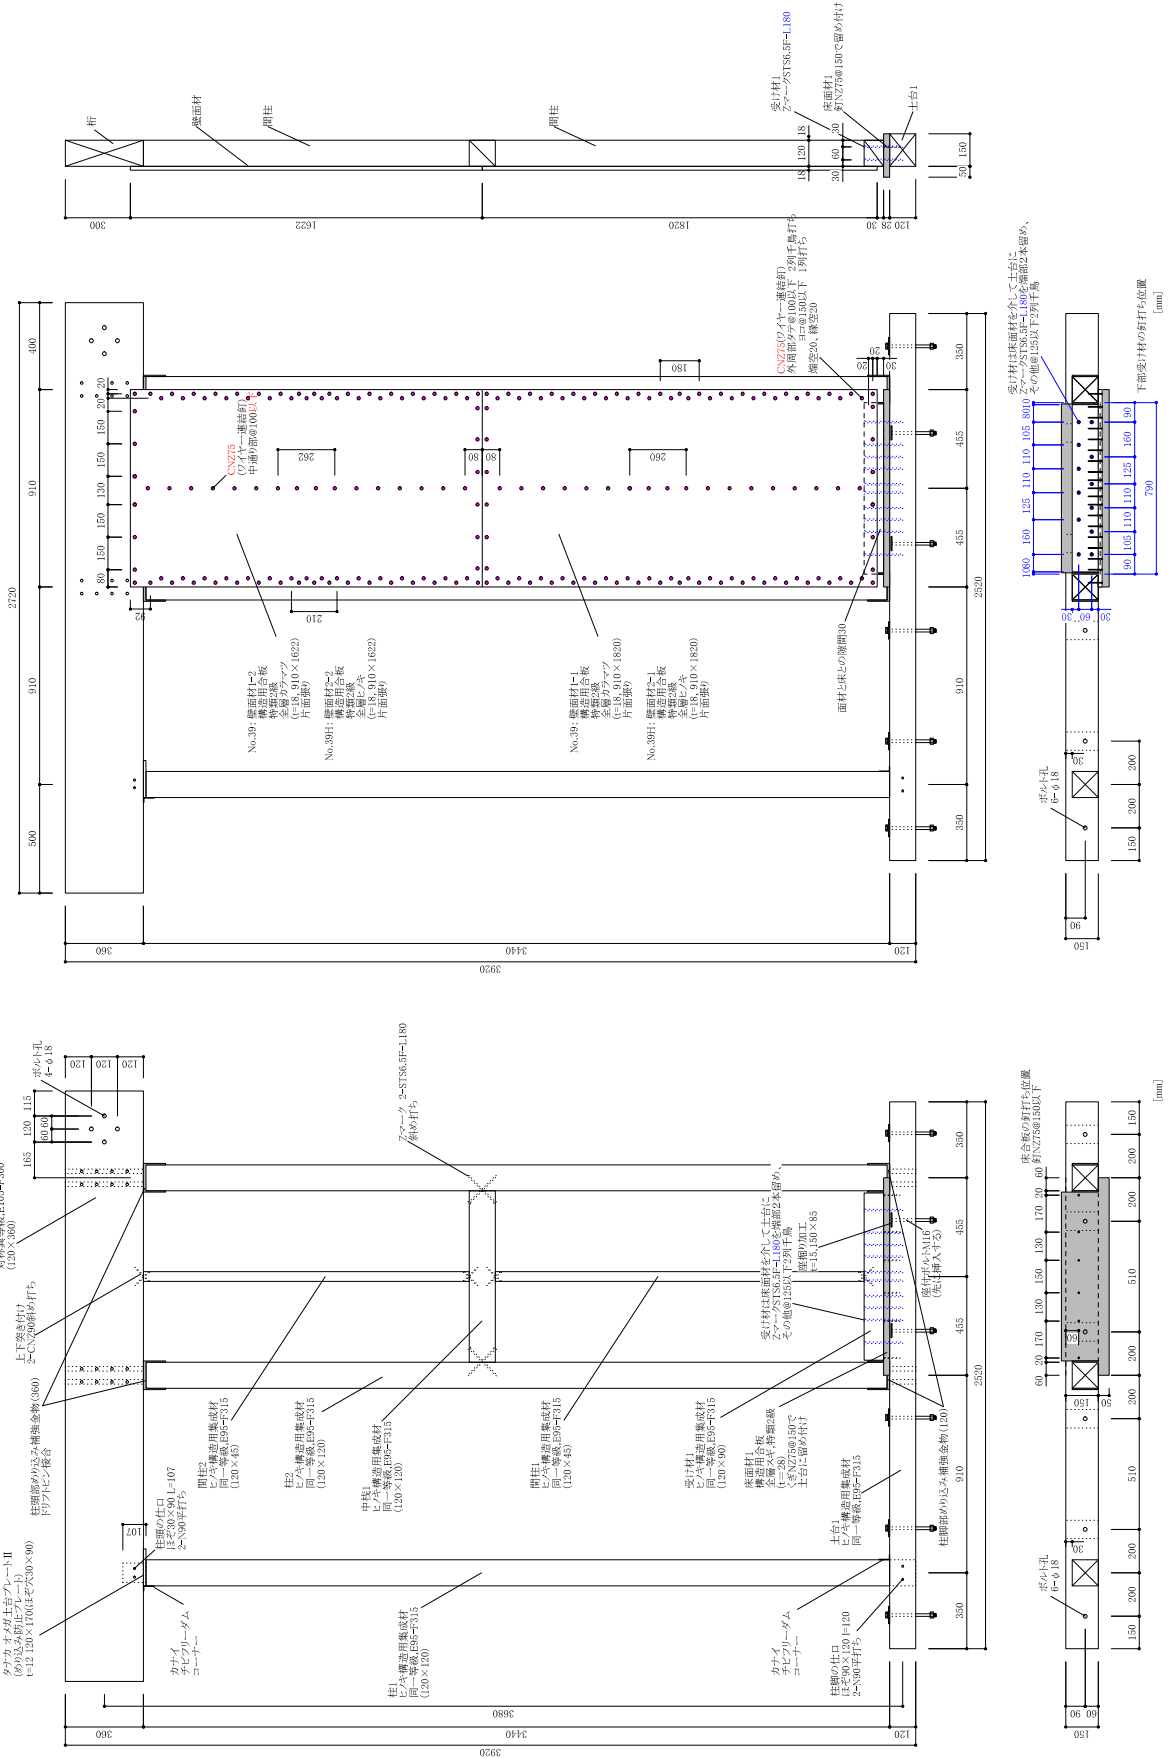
1: No.39-1, No.39H-1 試験体の詳細図 (mm)
